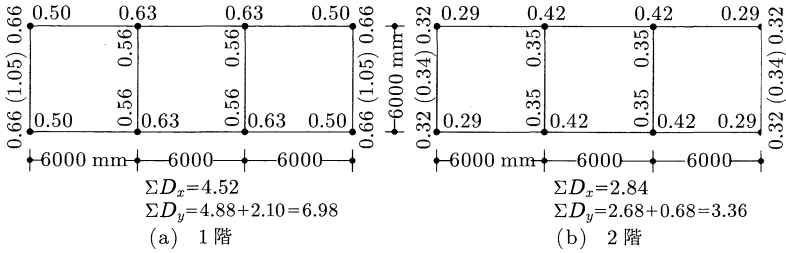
柱および耐震壁の分担率 (() は耐震壁)
